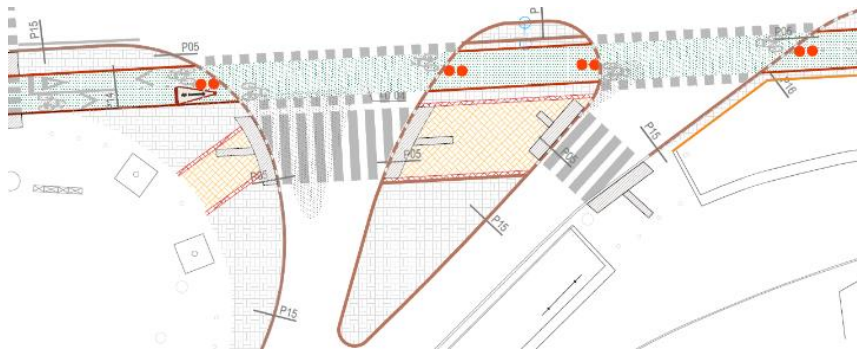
Pavimento em bloco dbetão do tipo PAVE [13]
